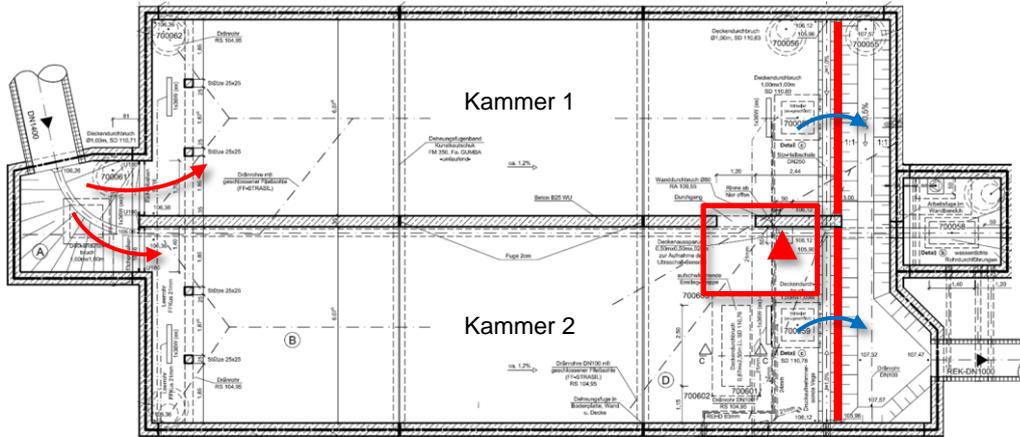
Grundriss des RÜB „Volumen“ aus Planunterlagen
